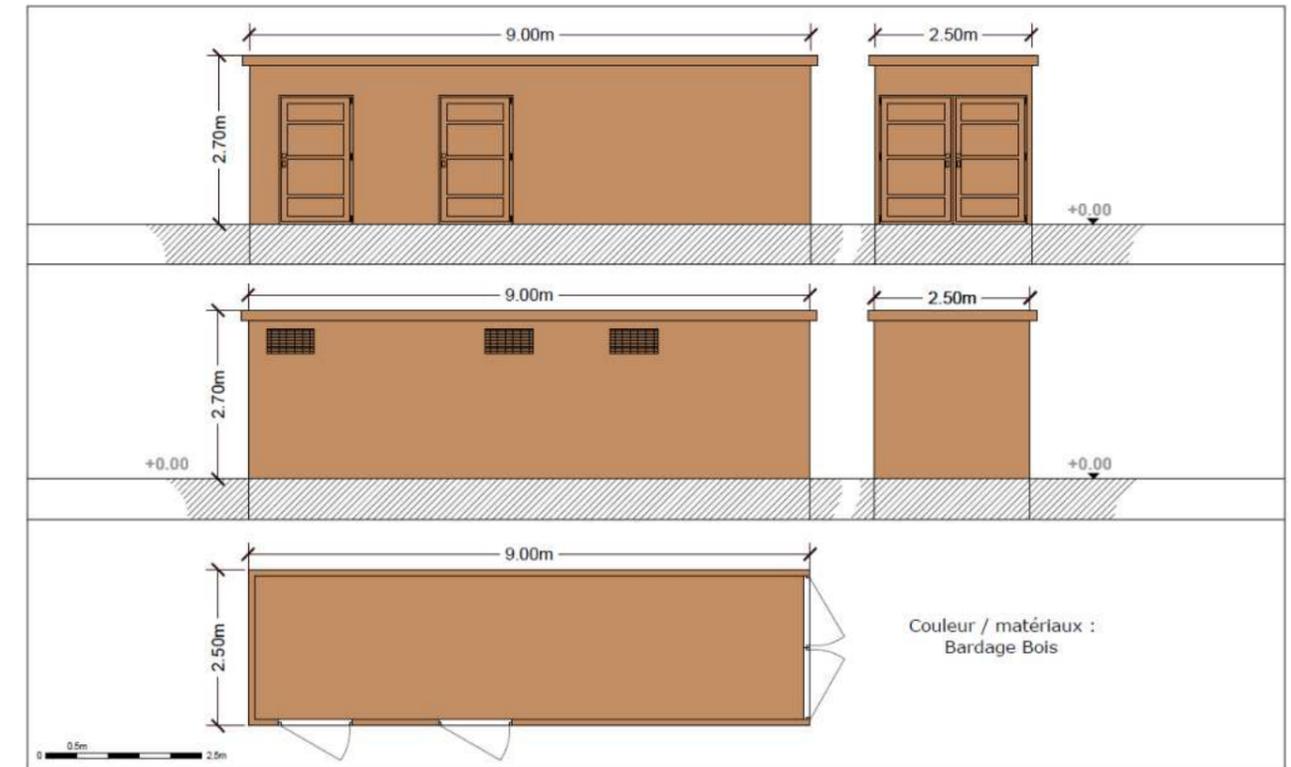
Plan des façades / Plan de coupe du PDL et local technique (Source : SOLVEO)
